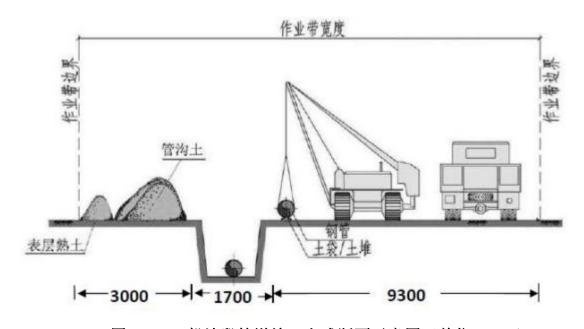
一般地段管道施工方式断面示意图(单位: mm)
